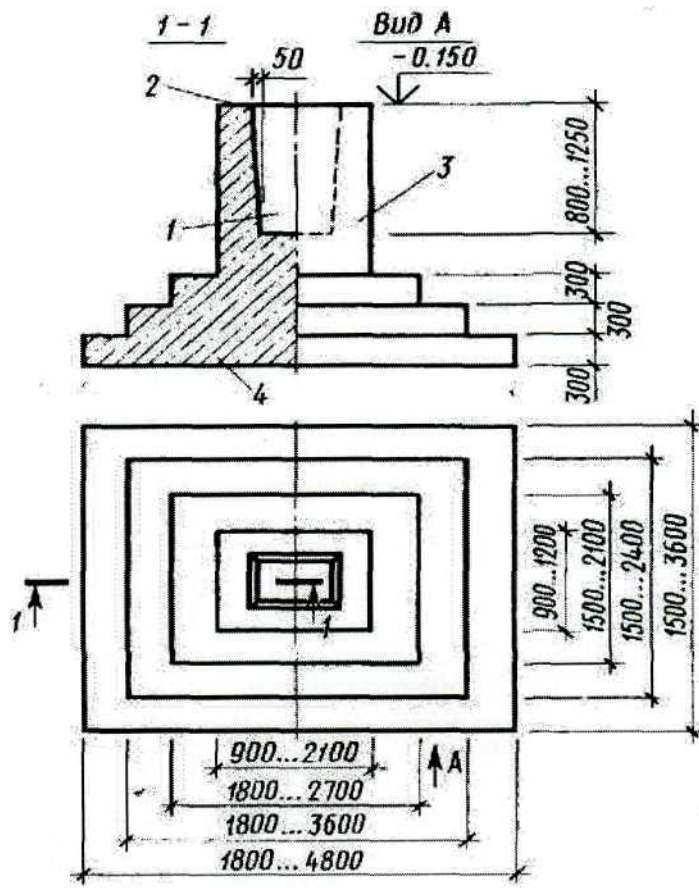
Железобетонный монолитный фундамент стаканного типа:
